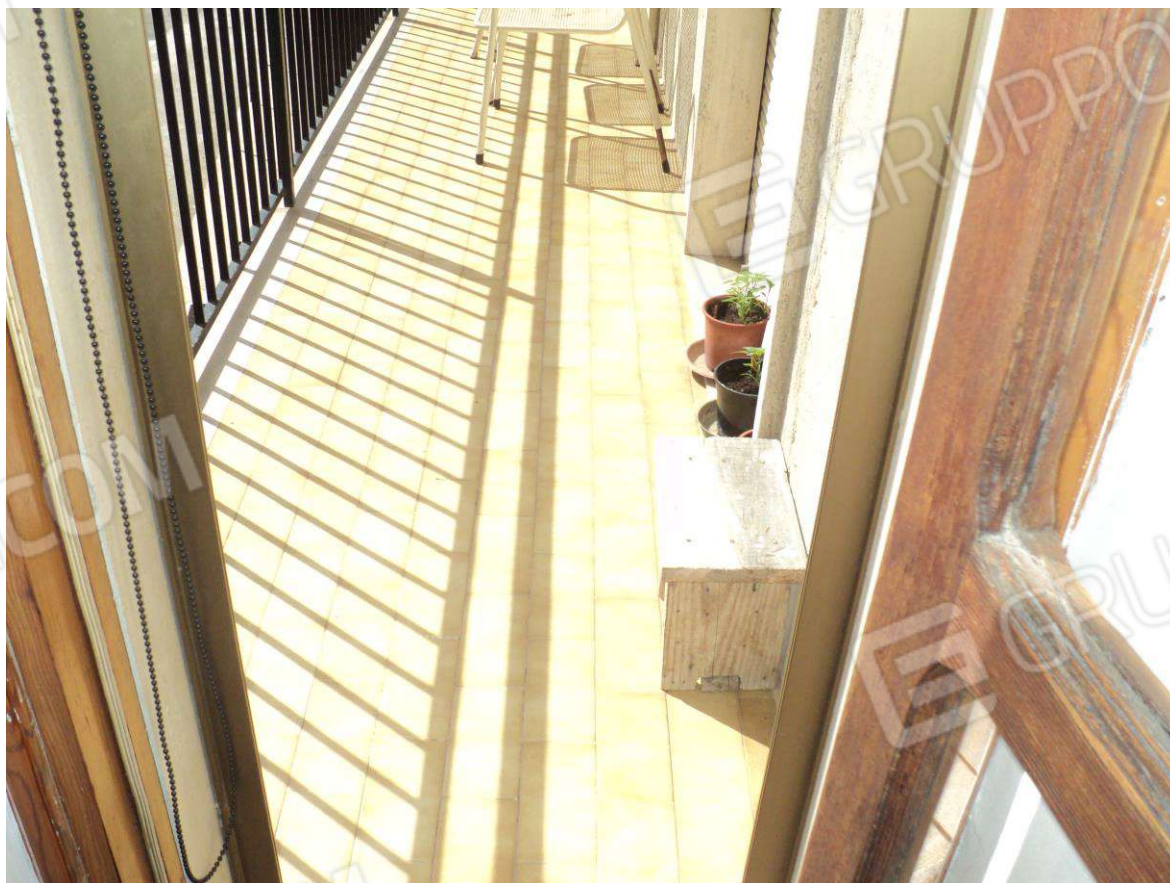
Particolare pavimentazione balcone e infisso in legno
